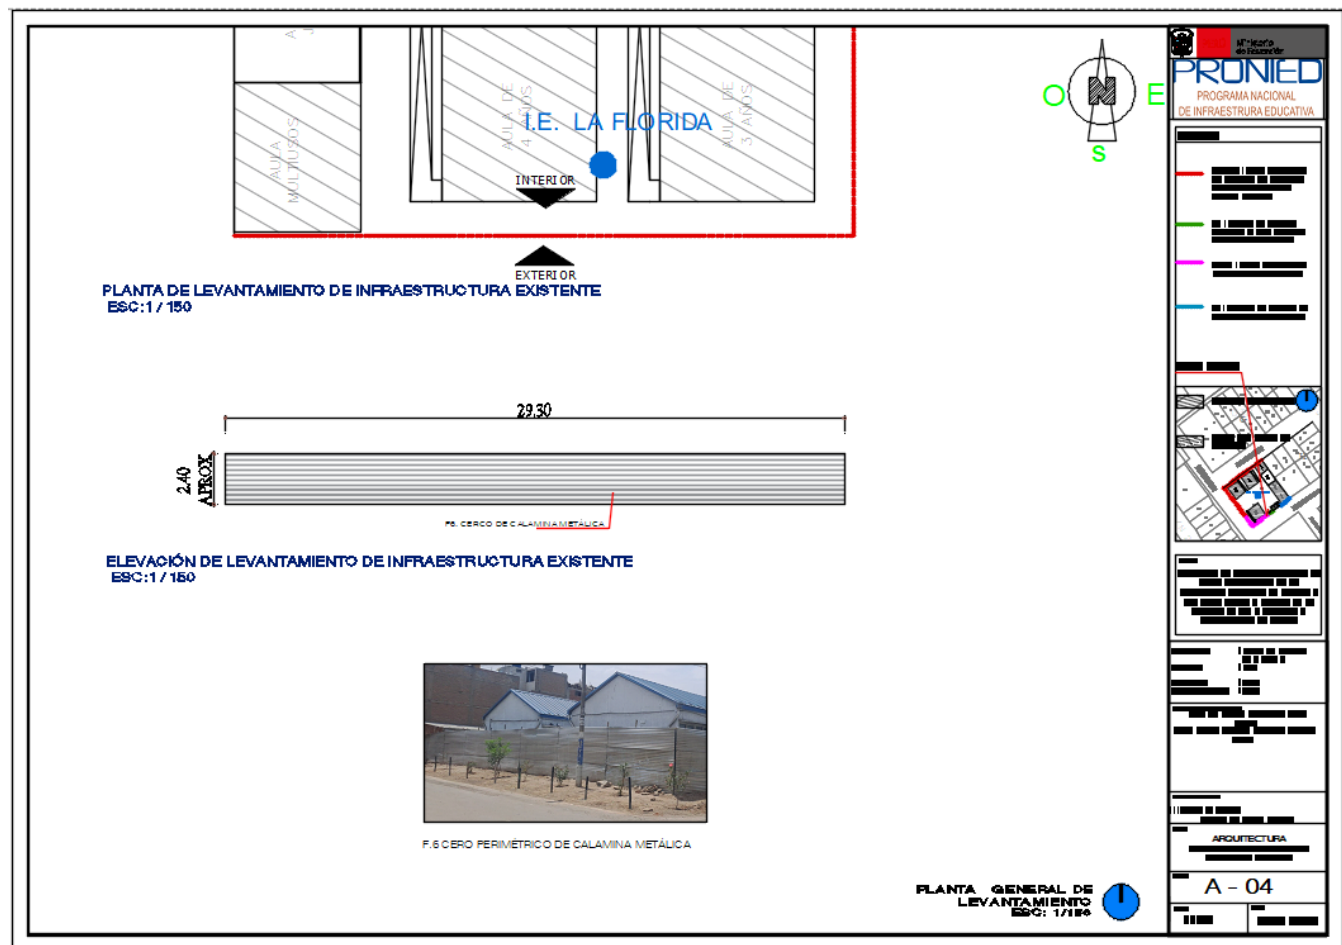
Plano de levantamiento de cerco perimétrico: Elevación hacia Calle Honduras, reemplazo de 29.30 ml de cerco.
